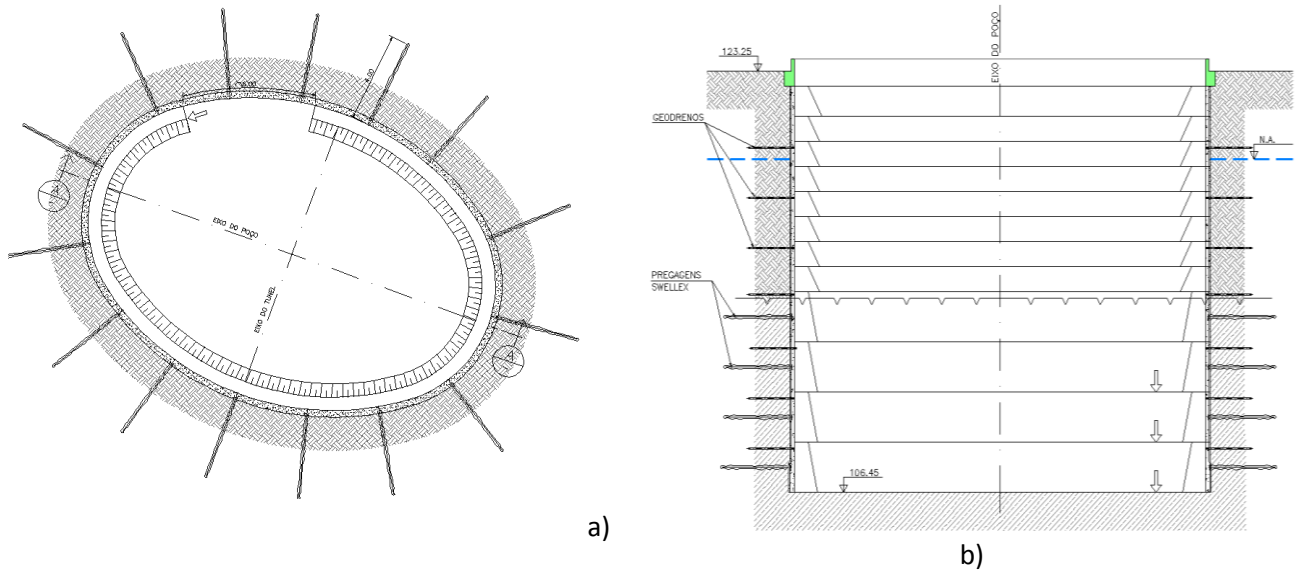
a) Planta do poço com o esquema de pregagens tipo swellex; b) Perfil da secção AA do Poço de Ventilação, com os níveis de escavação definidos (adaptado CJC, 2009).
